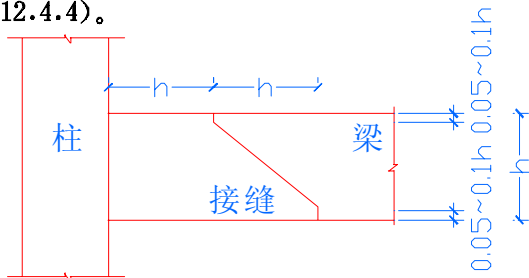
不同强度等级混凝土的梁柱施工接缝
